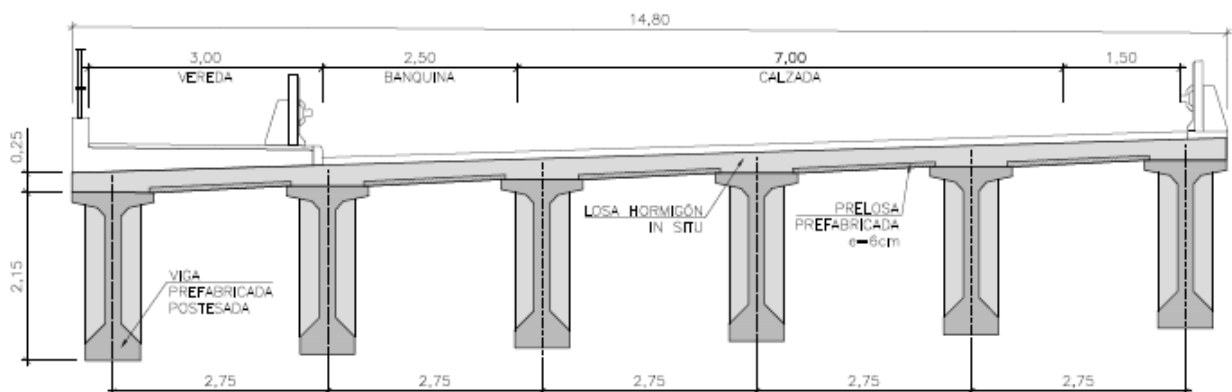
Sección tipo de tablero de vigas doble T para calzada sencilla.
